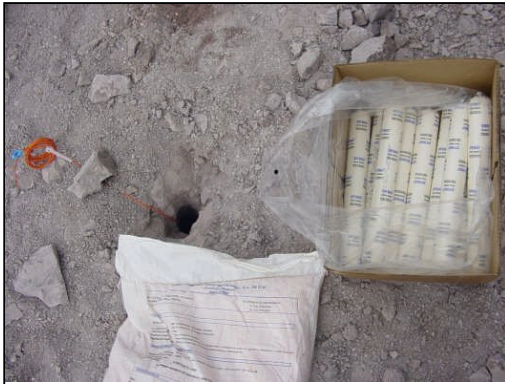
Un barreno visto desde planta con los materiales a un lado antes de cargarlo.
